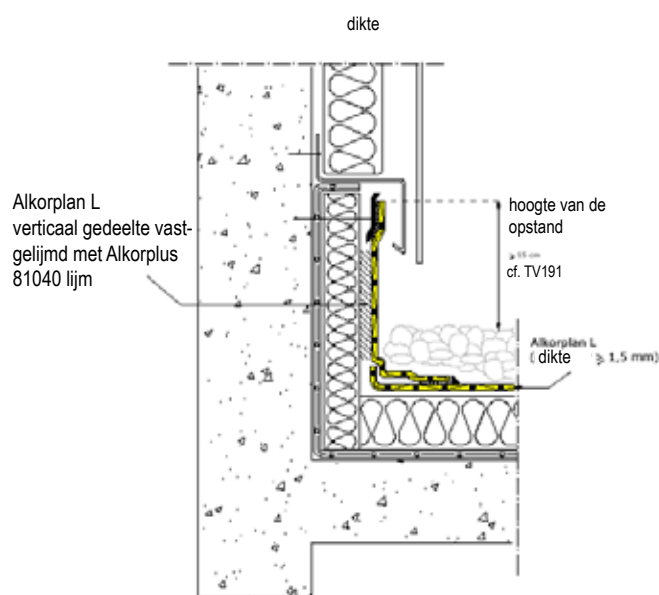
Typisch detail voor de opstand met Alkorplan® L van 1,5 mm dik (of dikker) met bedekking
